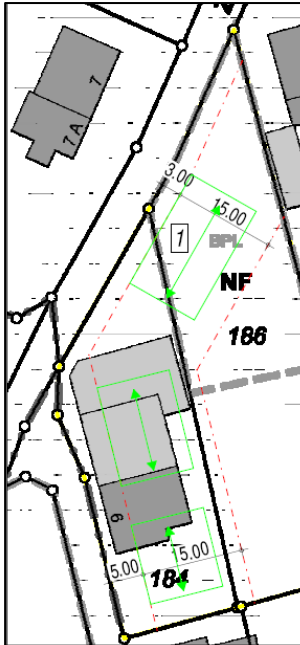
Fa. Müllerbau, Schweich, B-Plan Änderung Schillingen – Im Kandel - Bebauungskonzept, Mai 2021, Auszug, ohne Maßstab
